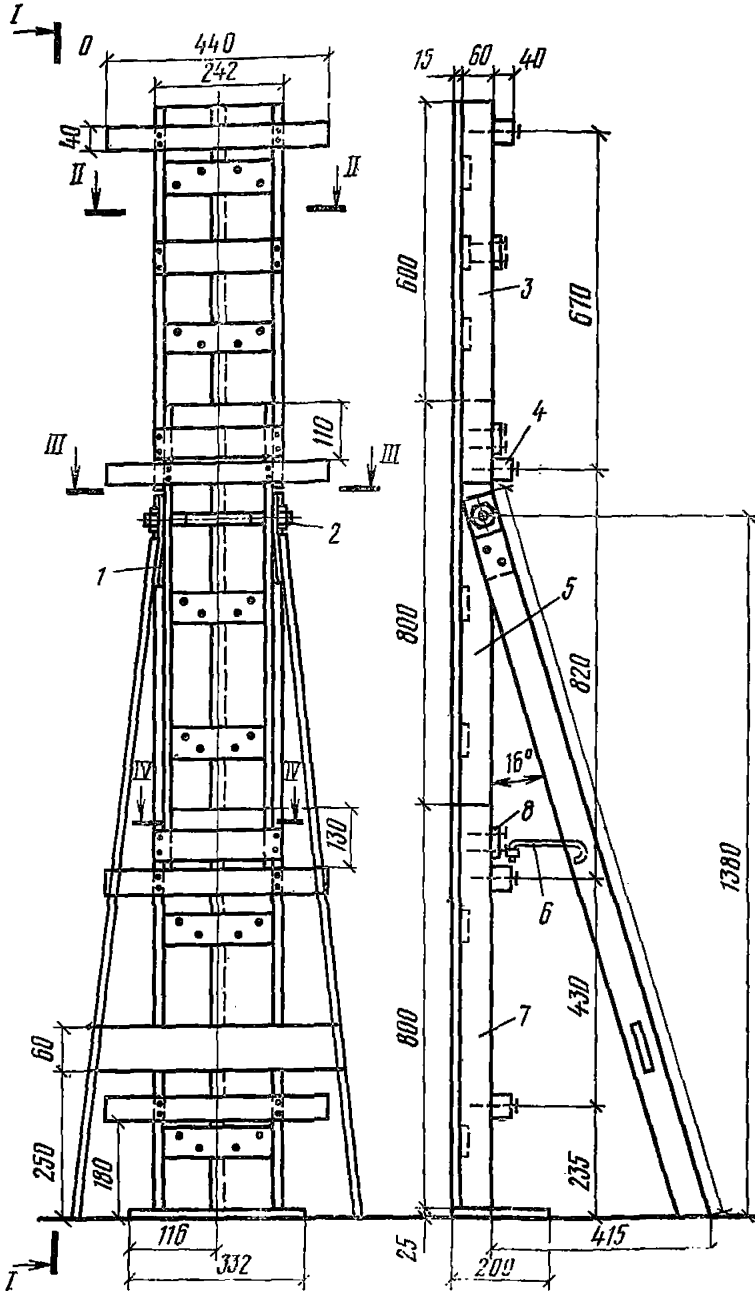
Сборно-разборная щитовая опалубка для утепления вертикальных углов (общий вид); разрезы и детали, см. рис. 2
